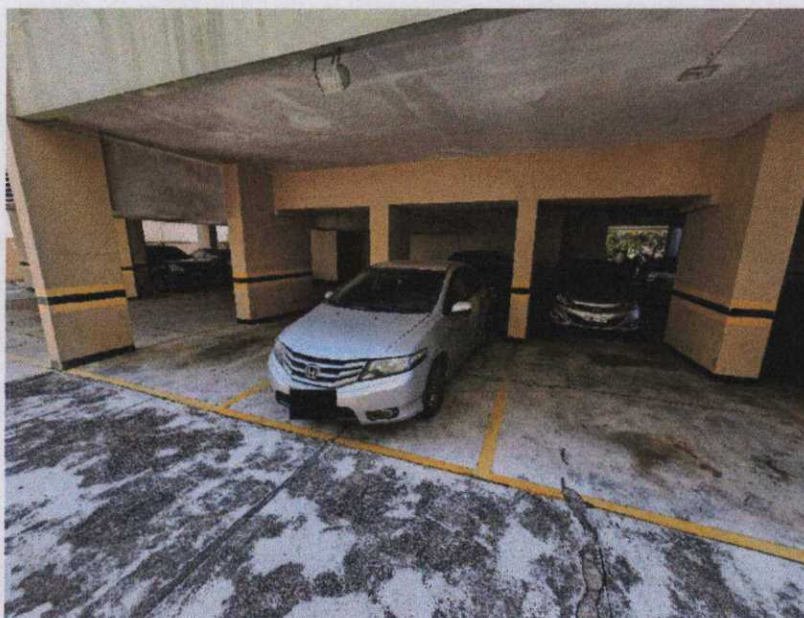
Vista da garagem do pavimento térreo apresentando os seguintes padrões construtivos: piso cimentado; alvenarias e teto em pintura látex pva acrílica sobre emassamento.
